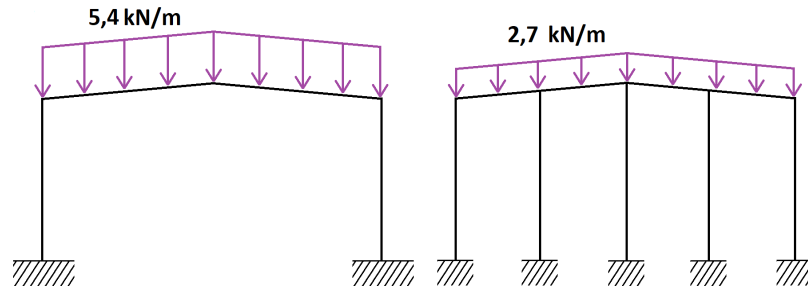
Cargas de nieve sobre los pórticos interiores y de fachada
